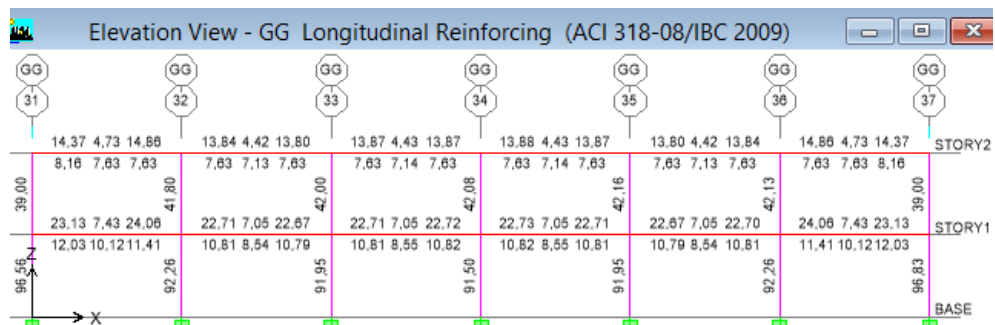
Acero en Vigas y Columnas en el Pórtico GG – Obstetricia - (NEC-11)
